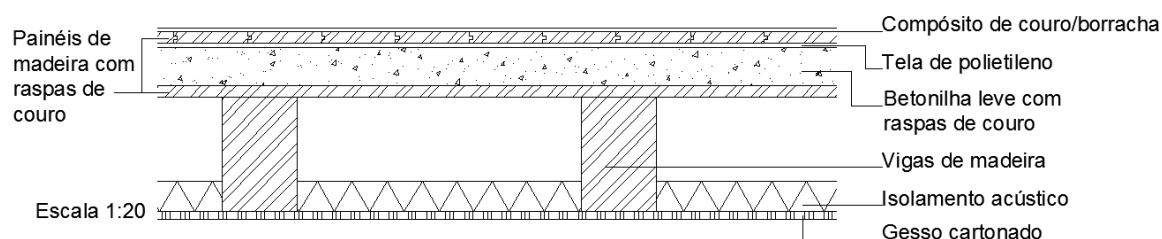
Detalhe construtivo de pavimento com junção de painéis de fibras de madeira com raspas de couro, betonilha leve com grânulos de couro e compósito de couro/borracha
